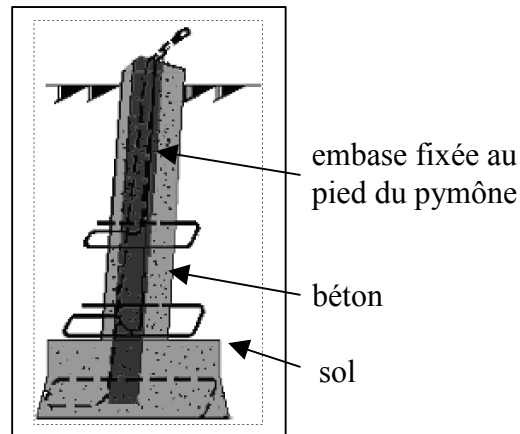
Embase et fondation d'un pied de pylône HTB.
